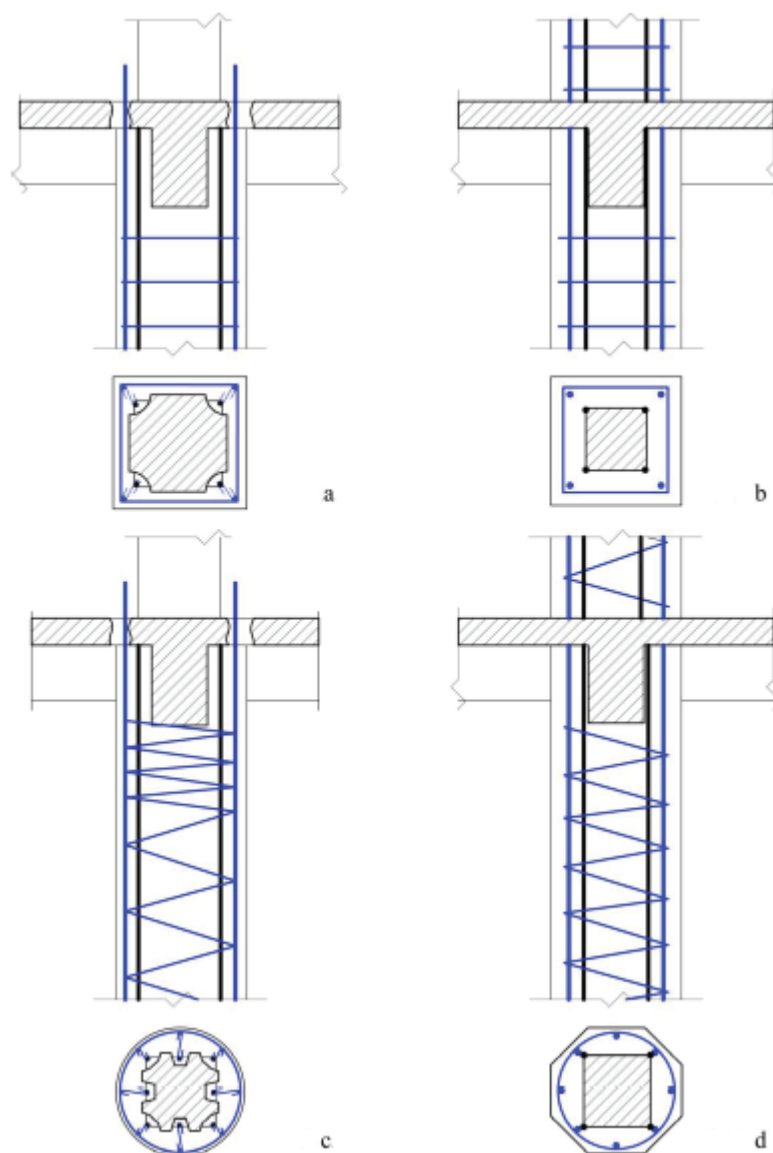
Variante de refacere a capacității portante la stâlpi de beton armat prin cămășială de beton
